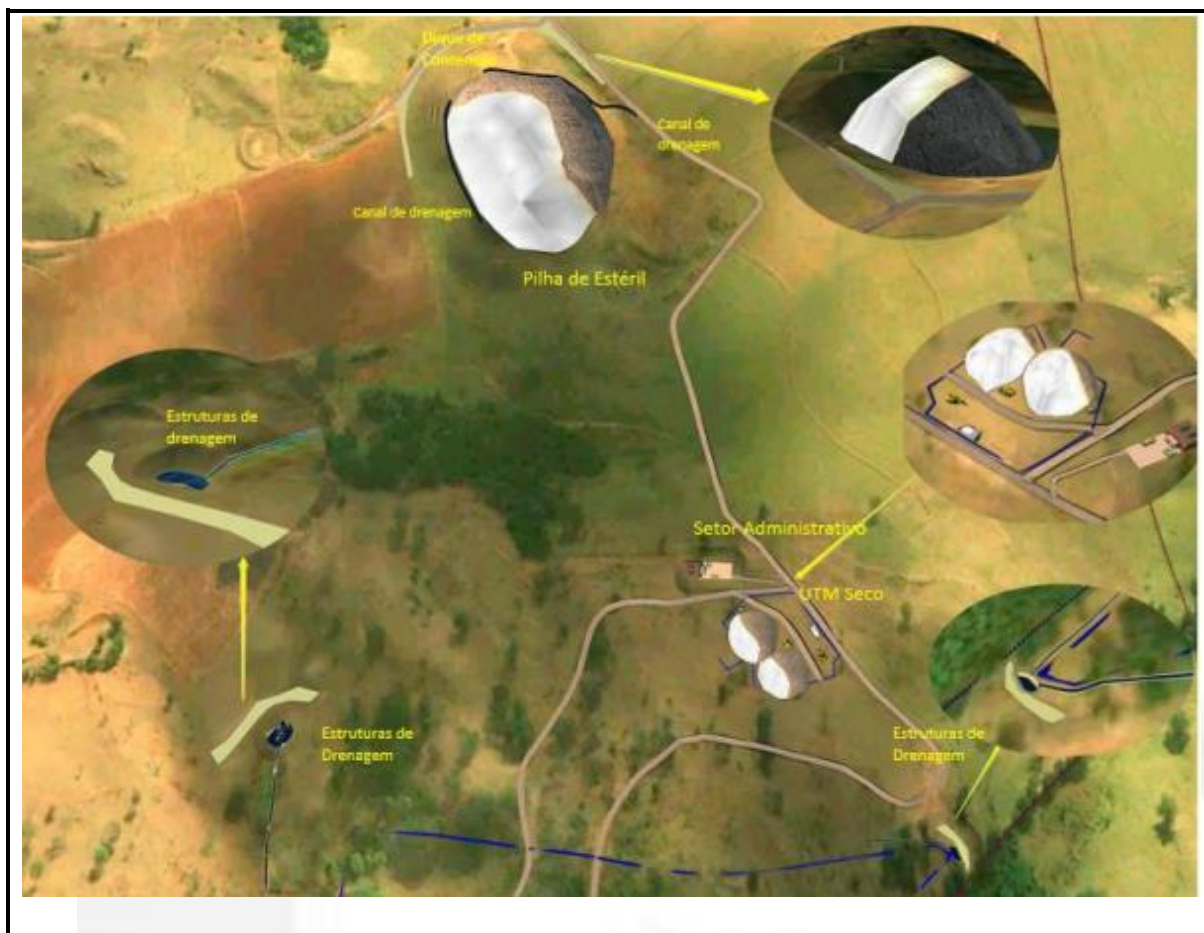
Demonstrativo da planta com as estruturas de drenagem
